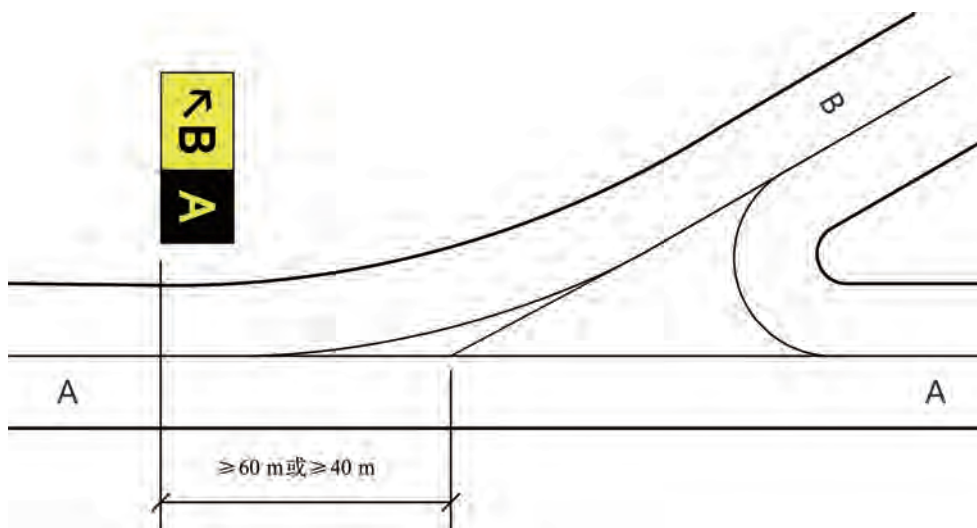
滑行道交叉处标记牌的布置示意图（三）
